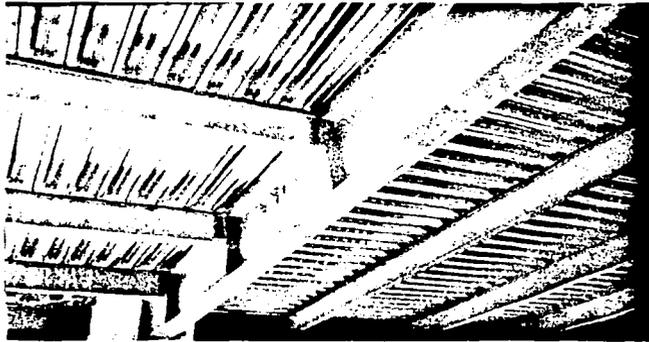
Armado y cimbrado de traves amarteladas en niveles superiores.
